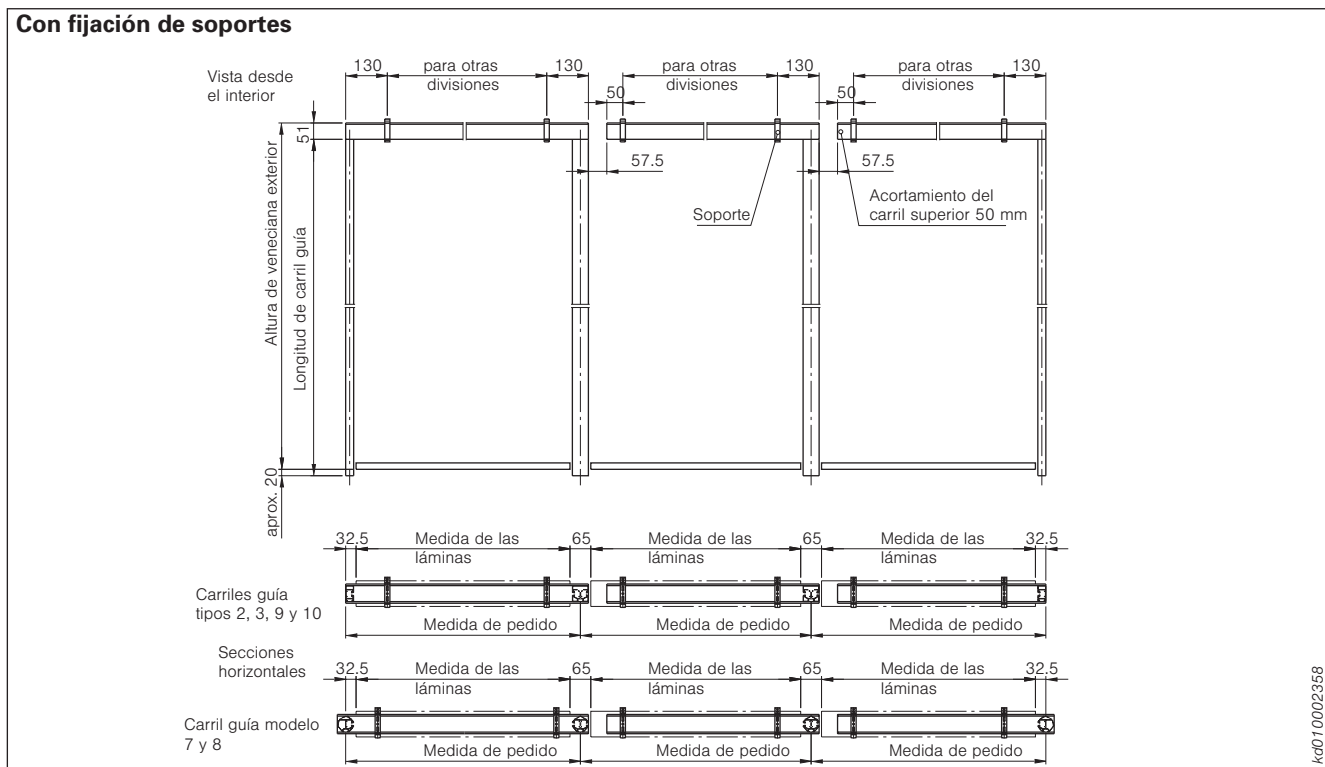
Guía de medidas montaje del carril superior sobre los carriles guía
